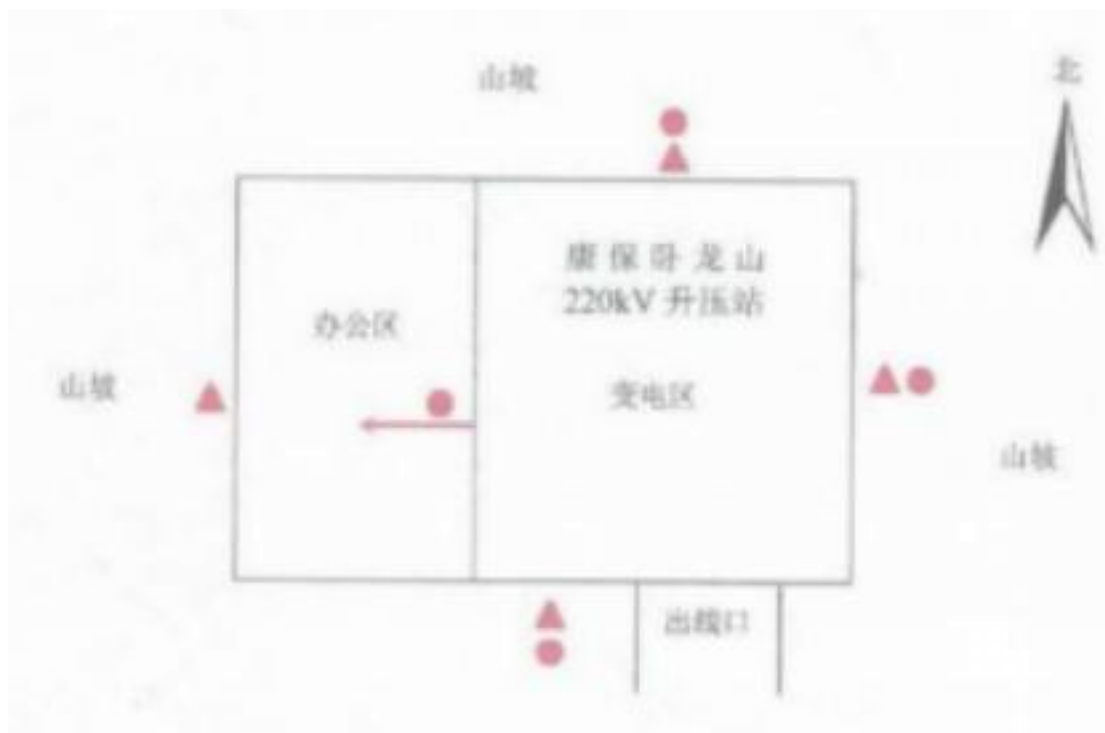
类比 220kV 升压站总平面布置及监测点布置图
